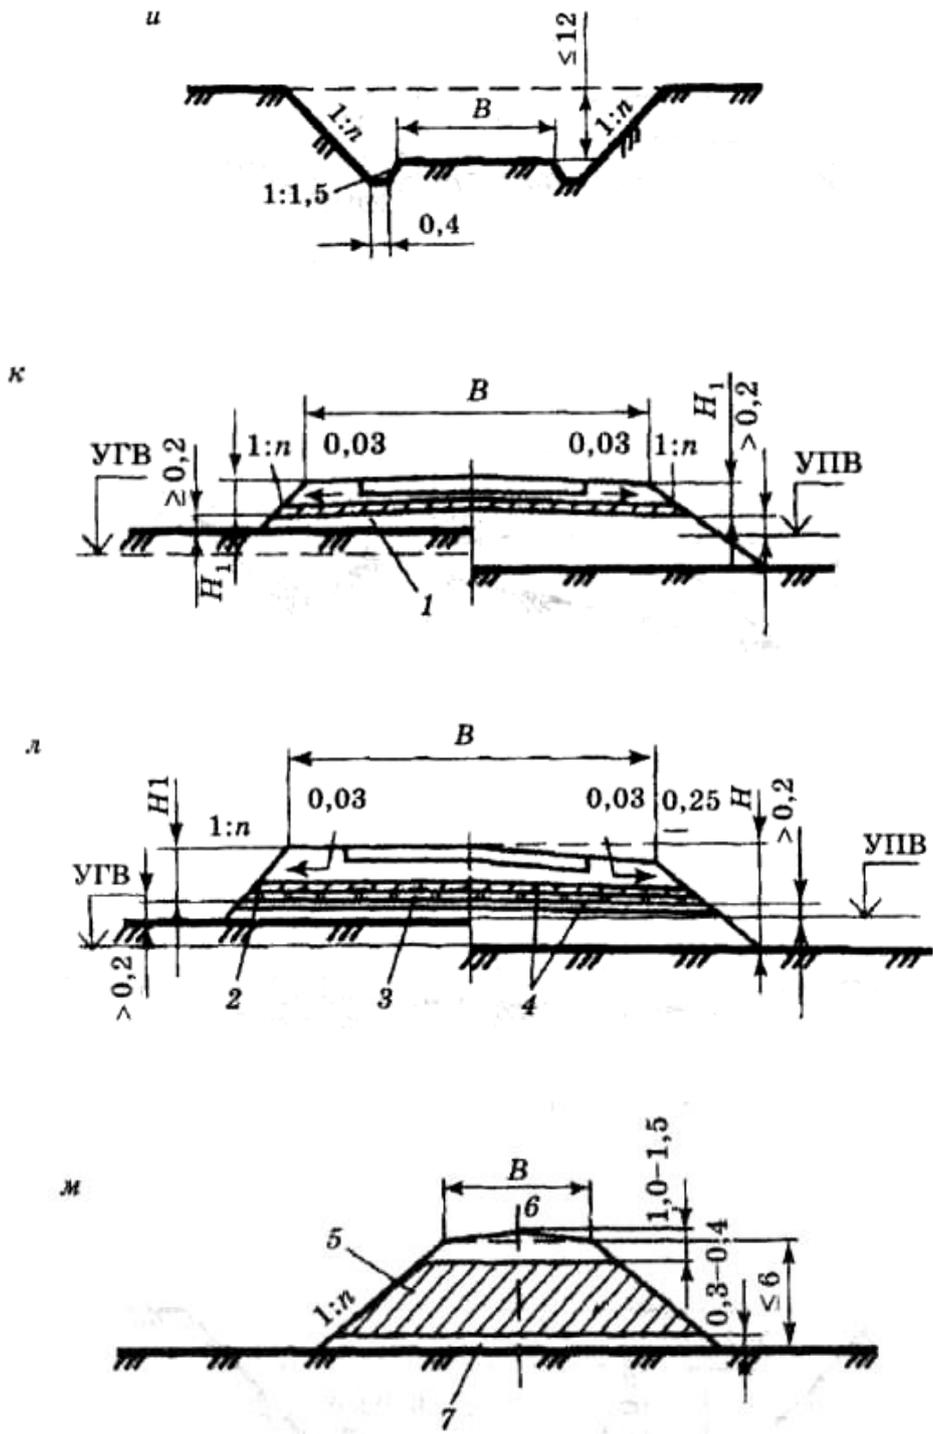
Окончание (начало см. на с. 43-44): *u* - выемка в глинистых грунтах; *к* - насыпь с гидроизолирующей прослойкой; *л* - насыпь с капилляропрерывающей прослойкой; *м* - насыпь из глинистого переувлажненного грунта; 1, 7 - гидроизолирующая прослойка; 2 - крупный гравий или щебень на выходе прослойки; 3 - капилляропрерывающий слой из гравия, щебня и т.п. толщиной 15...20 см; 4 - противозаиливающие слои; 5 - глинистый грунт; 6 - дренирующий грунт
